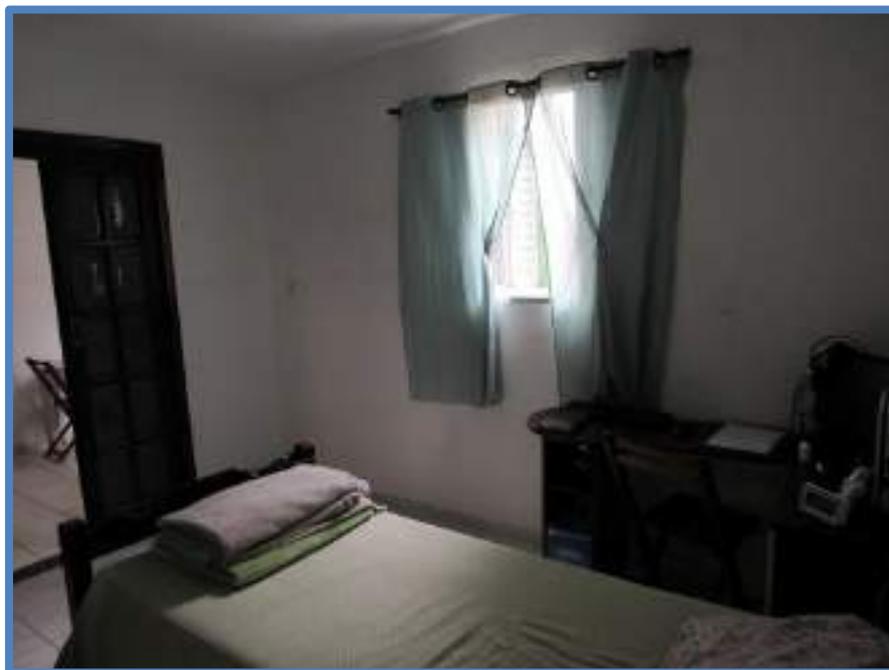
Casa, Primeiro Subsolo, Dormitório 01.
